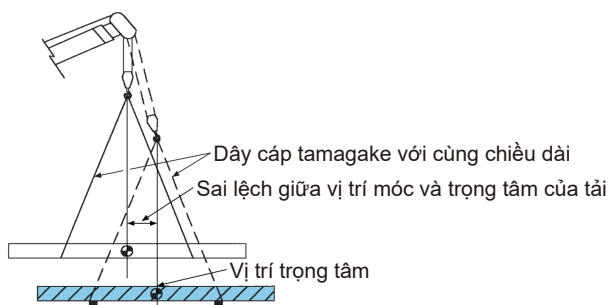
Cấm Kéo tải Sang ngang hoặc Nâng theo Đường chéo
